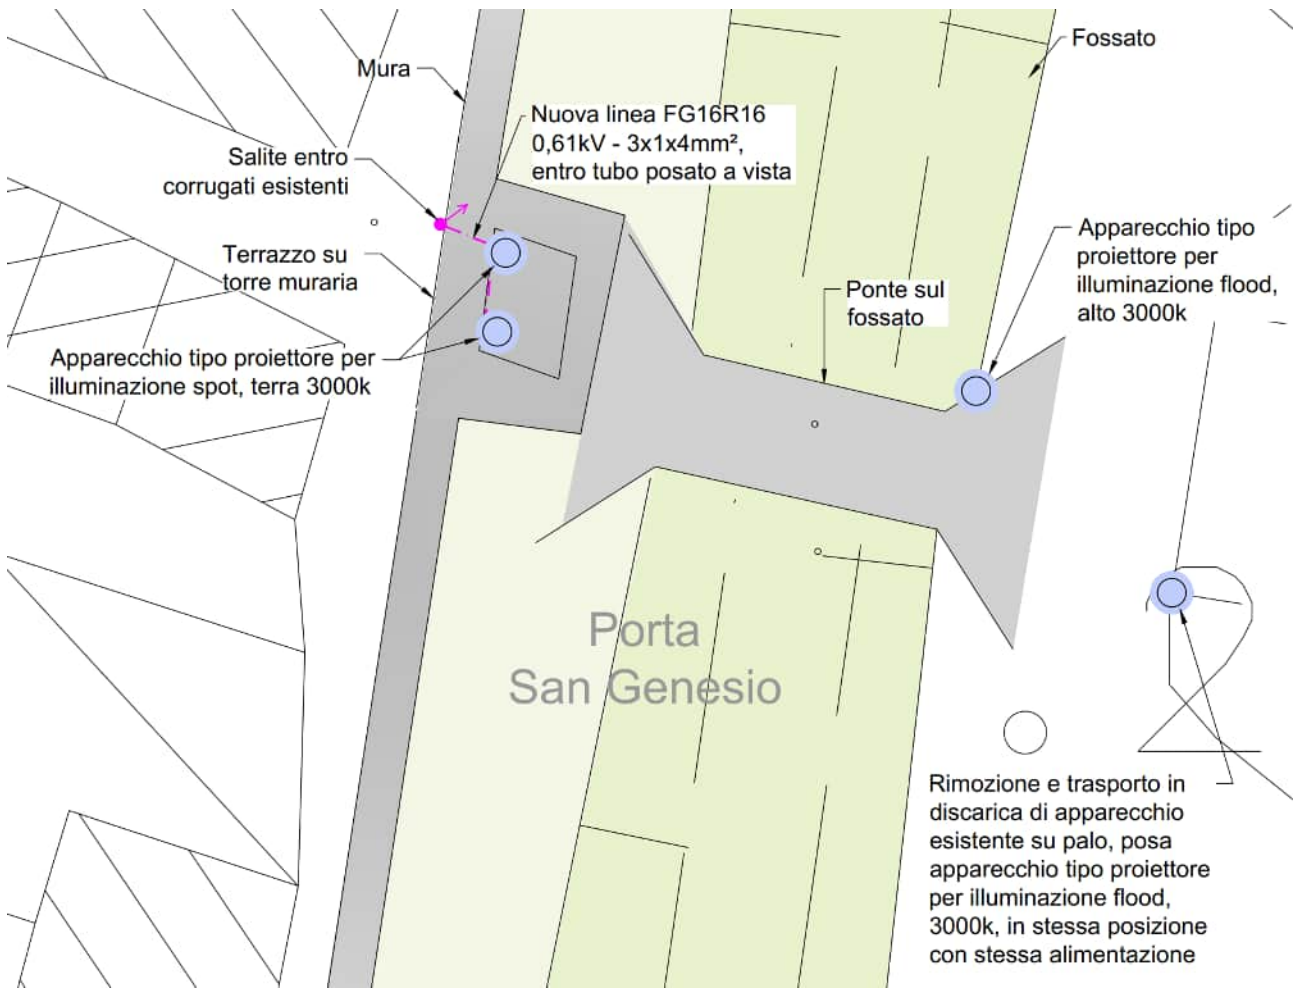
Planimetria di progetto illuminazione Porta San Genesis
